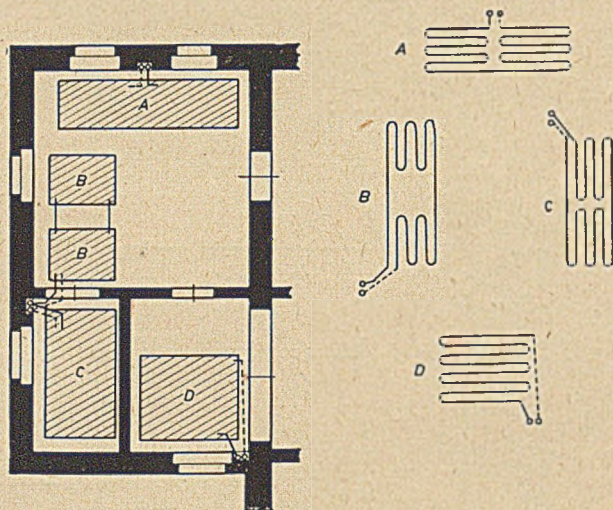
Entwurfschema einer Deckenheizung (Grundriß) mit verschiedenen Registern A, B, C und D.
